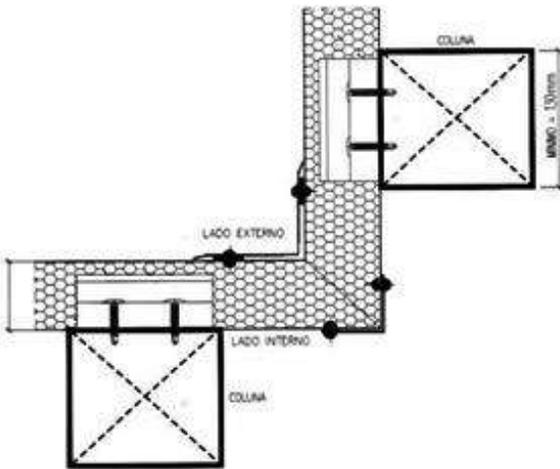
Detalhe de corte em planta da união de painéis adjacentes e da fixação do perfil de união lateral. (DÂNICA, 2013a)
